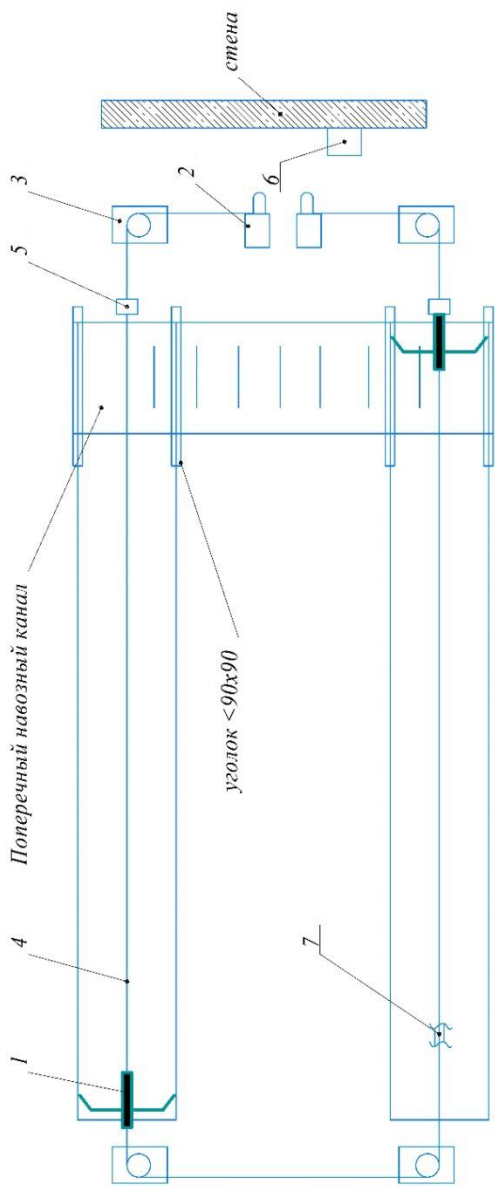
Скреперное навозоудаление с расположением навозного канала в торце коровника.
